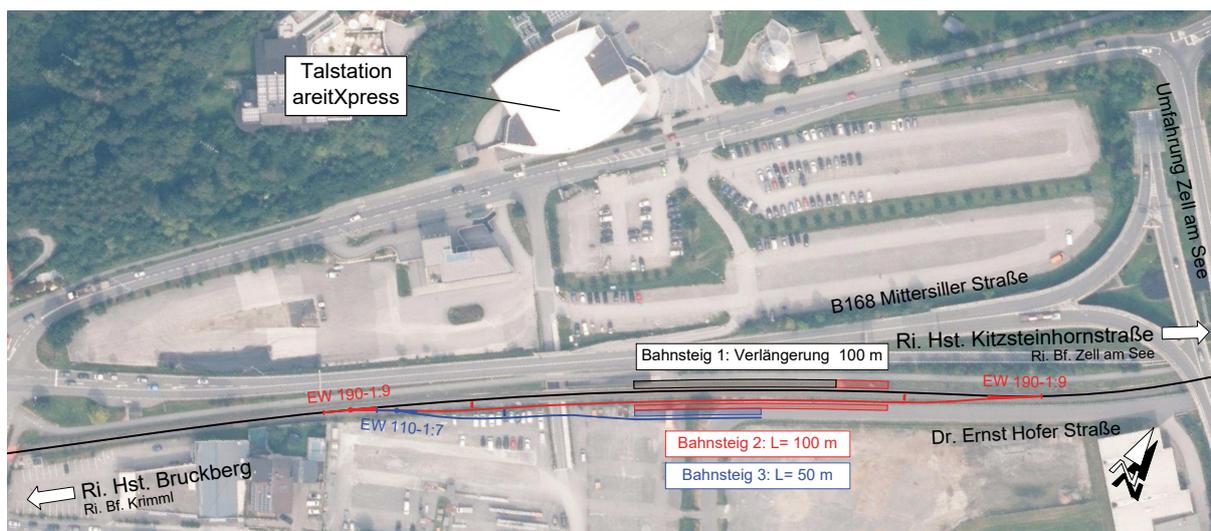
Lageplan des Bf. Areitbahn (M = 1:3000)
